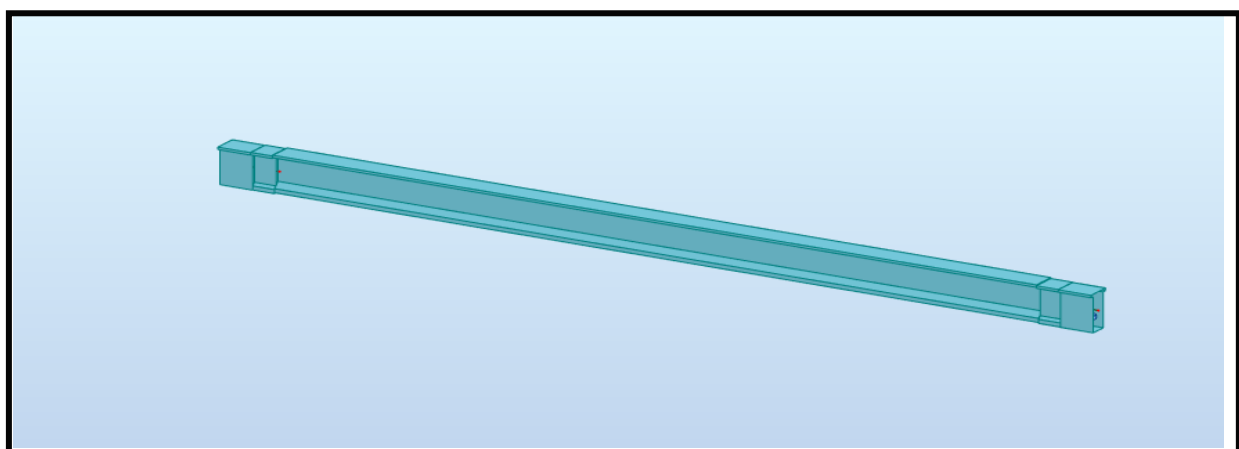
Modélisation de la poutre avec ces 5 partes
